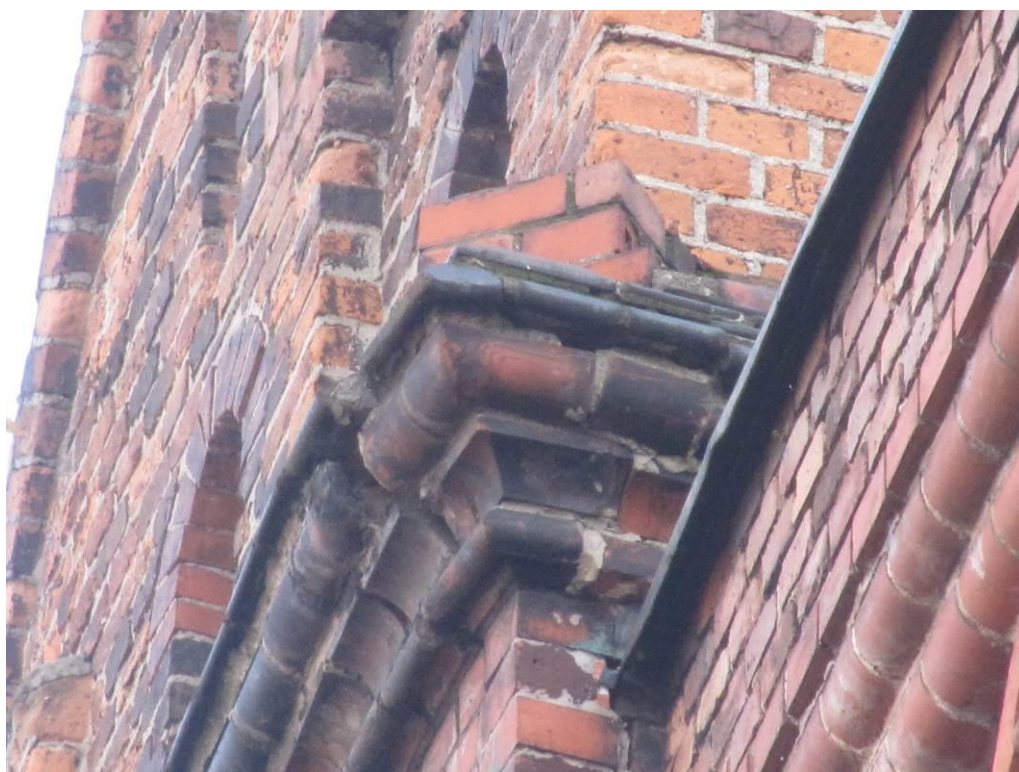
Górny fragment szczytu wieńczącego ryzalit fasady; deformacje pilastra, niestabilne elementy murowe
